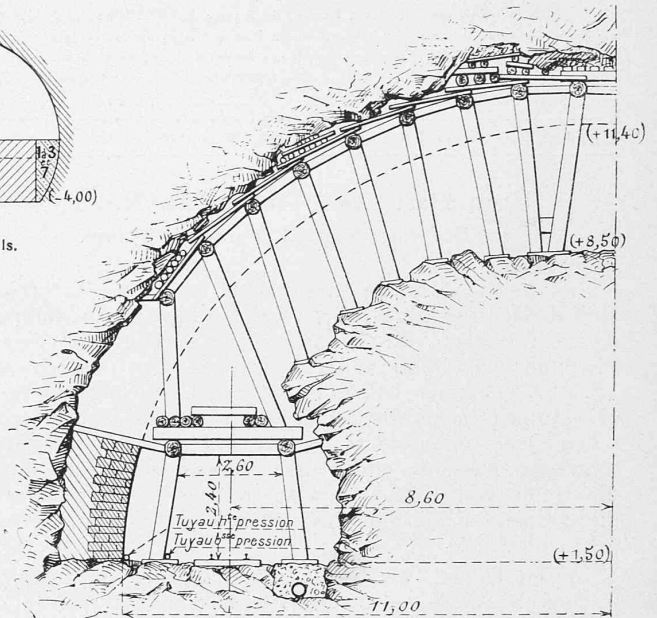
Zimmerung des Tunnel-Gewölbes.
